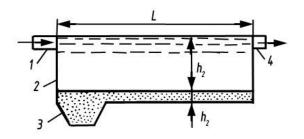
Схема горизонтальной песколовки: 1 – входной патрубок; 2 – песколовка; 3 – шламосборник; 4 – выходной патрубок
